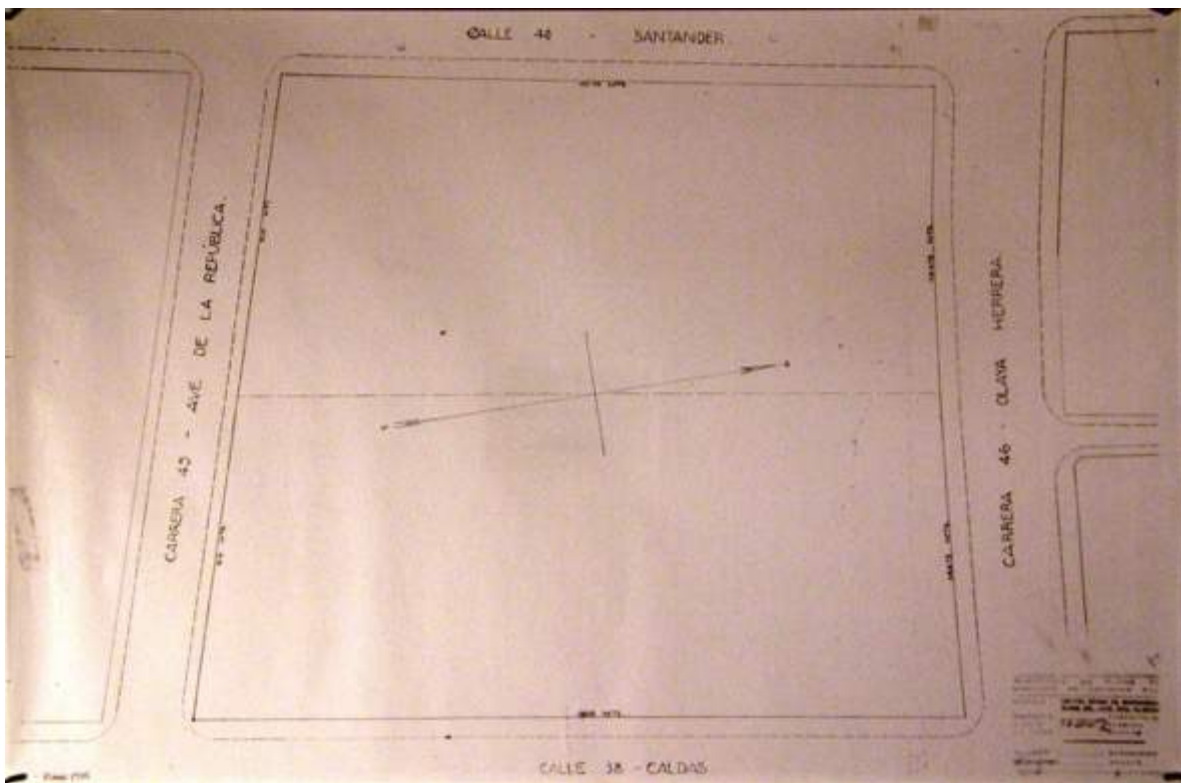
Plano 002. Proyecto 481. Plano del lote para el Edificio Nacional de Barranquilla. Dibujo de J.A. Bernal. Septiembre 18 de 1945. Original en el Archivo General de la Nación.
